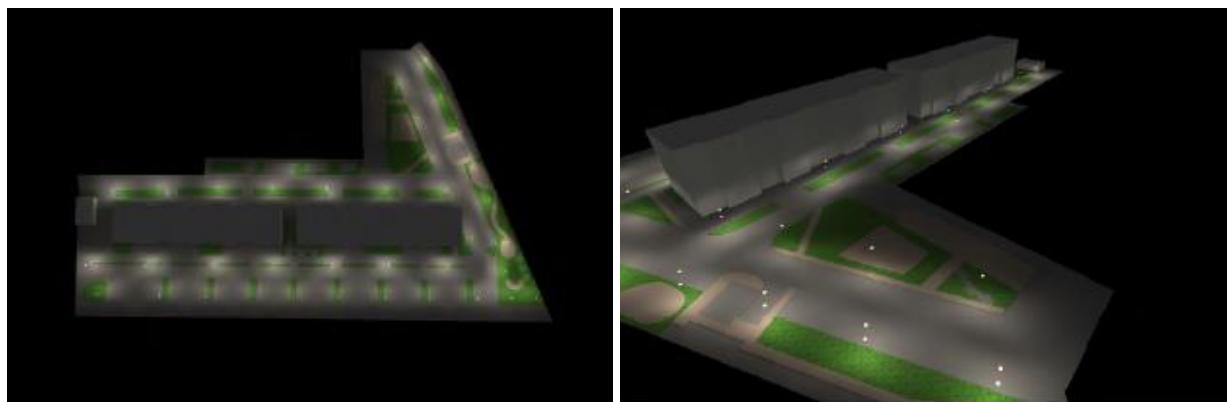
План освещения 1 очереди ЖК «Летний»
